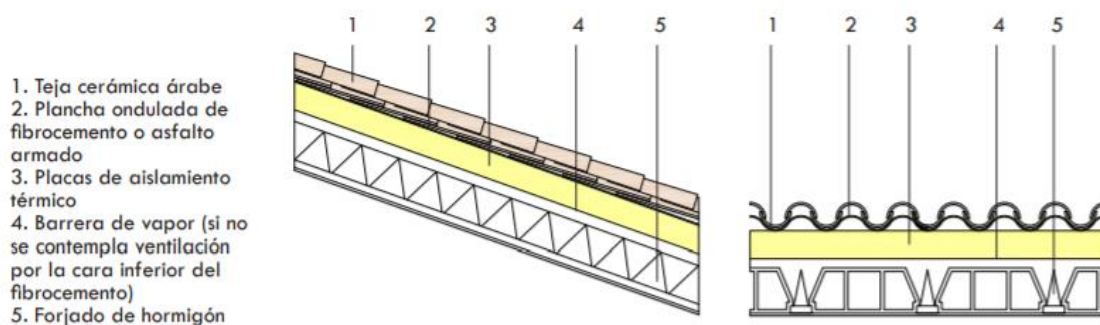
Detalle dunha cuberta co illamento polo exterior colocado baixo a cubrición.<sup>55</sup>
